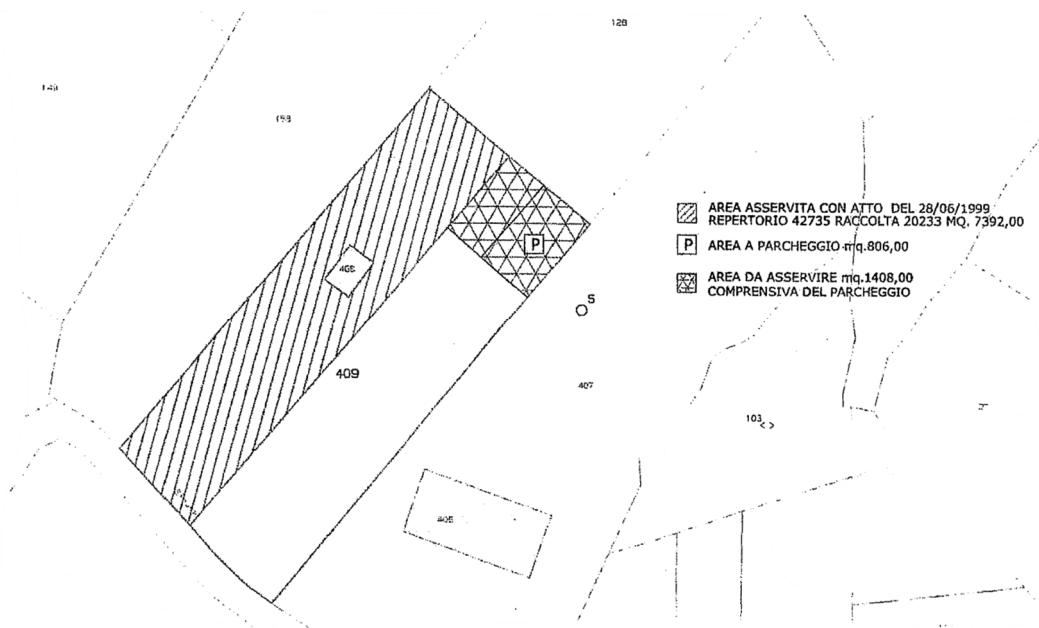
Planimetria catastale con indicazione delle superfici asservite
